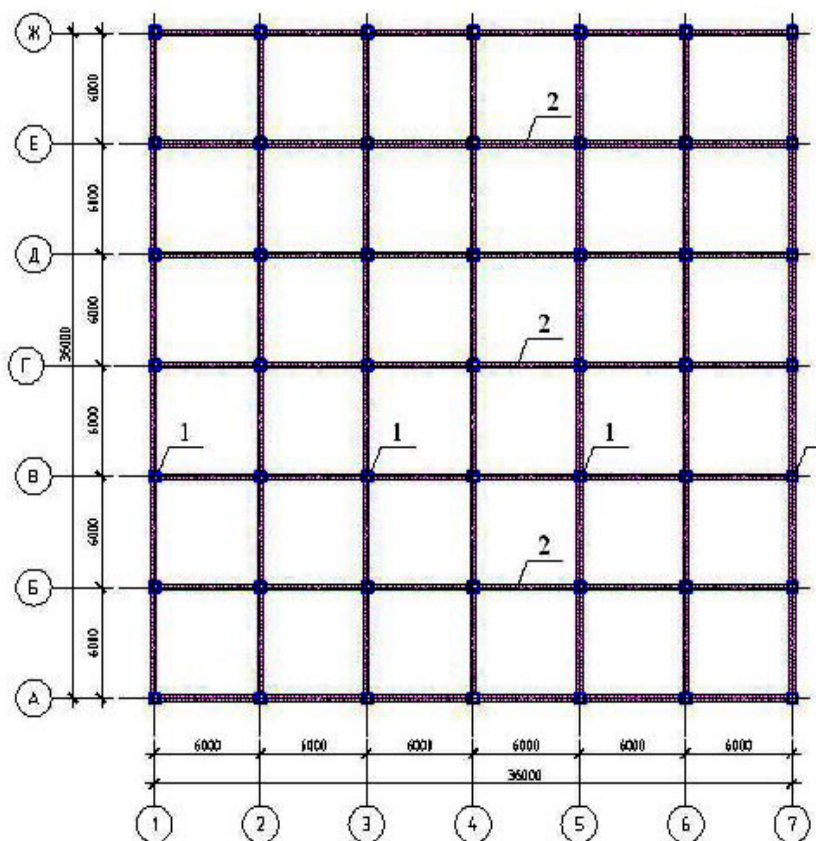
План типового этажа. 1 – колонны, 2 – диафрагмы перераспределяющего блока (только на 12 и 24 этажах)
